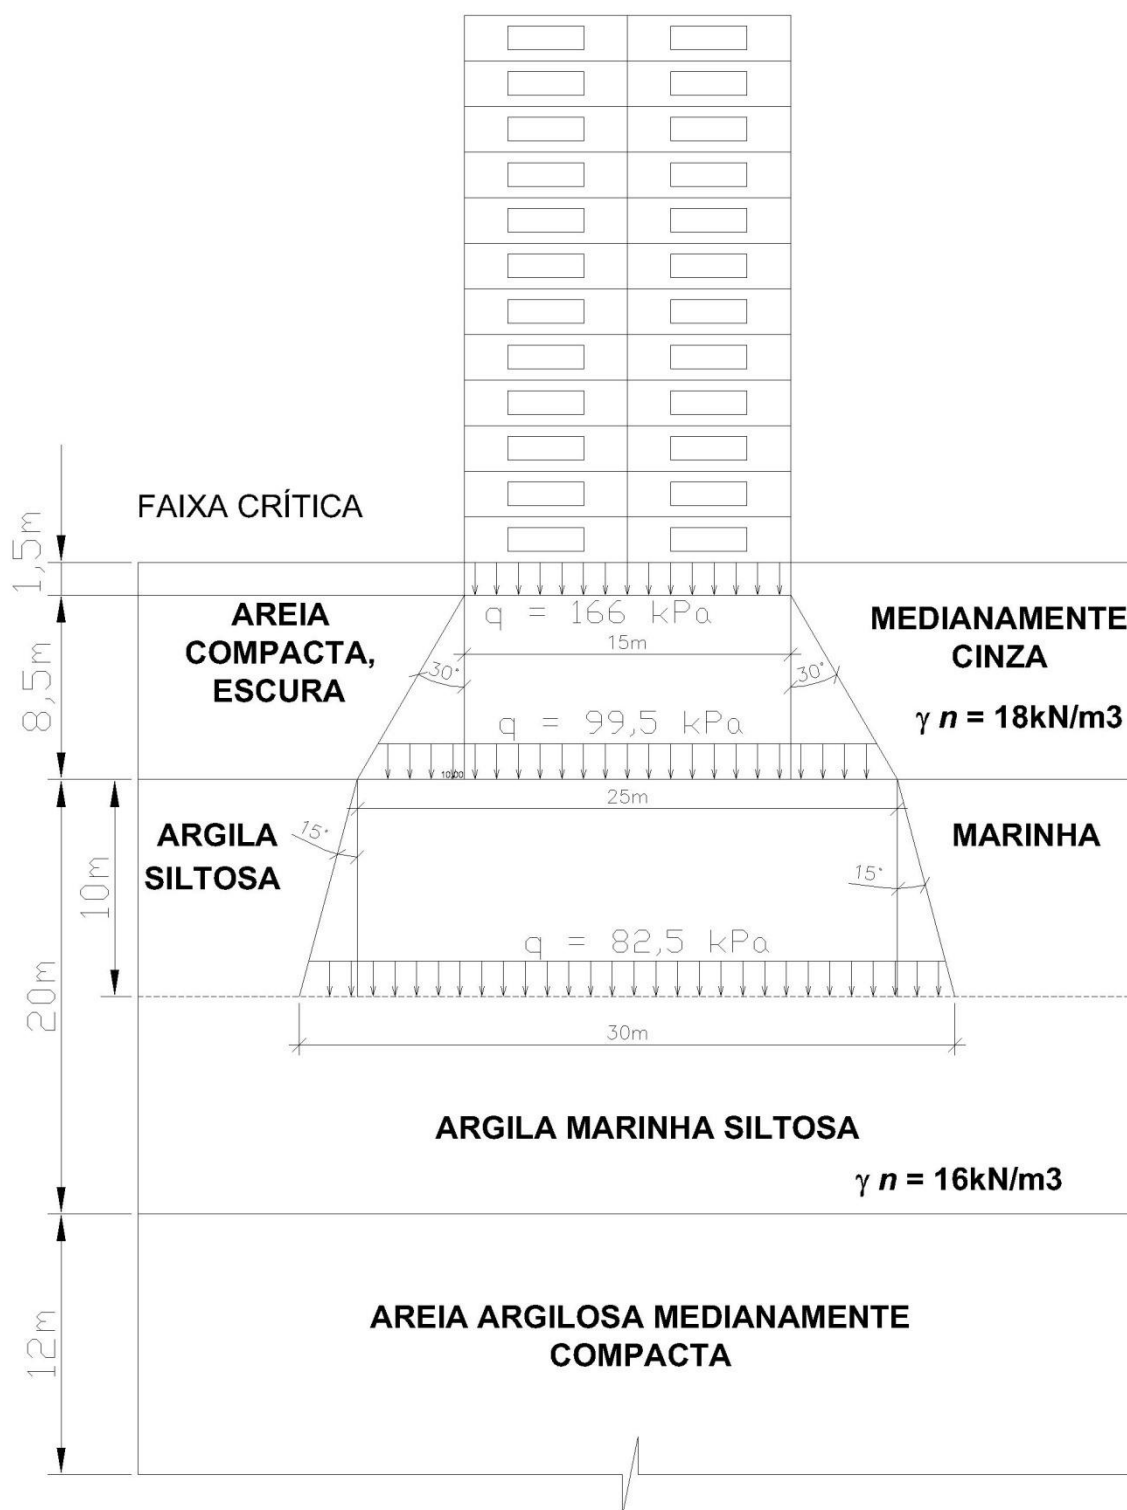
Esquema de dissipação de cargas para o perfil adotado da “Faixa Crítica” edifício “B”, com 12 pavimentos
